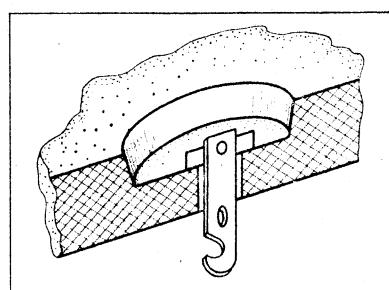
Крюк для подвески к плите перекрытия светильников массой до 5 кг
